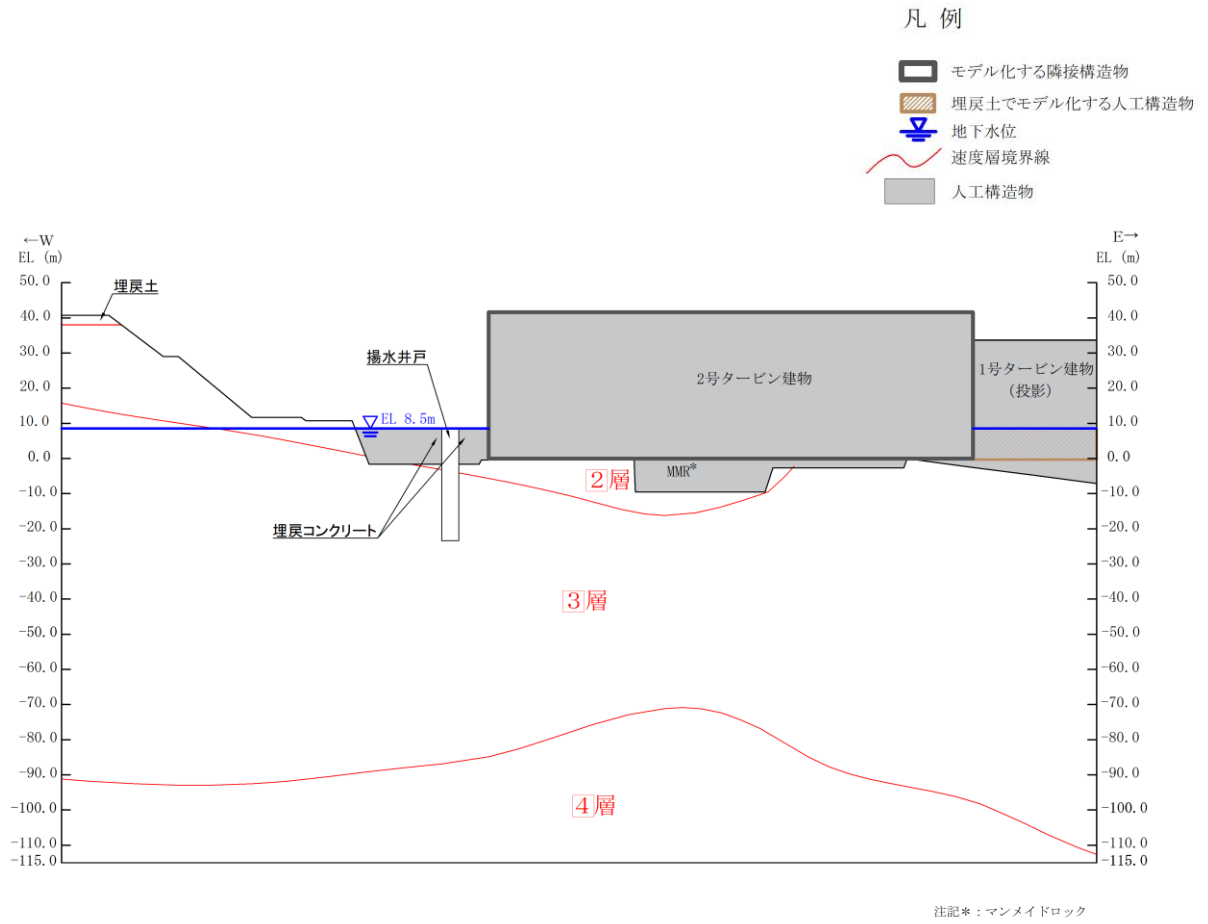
評価対象断面図 (A-A 断面 (東西方向))
